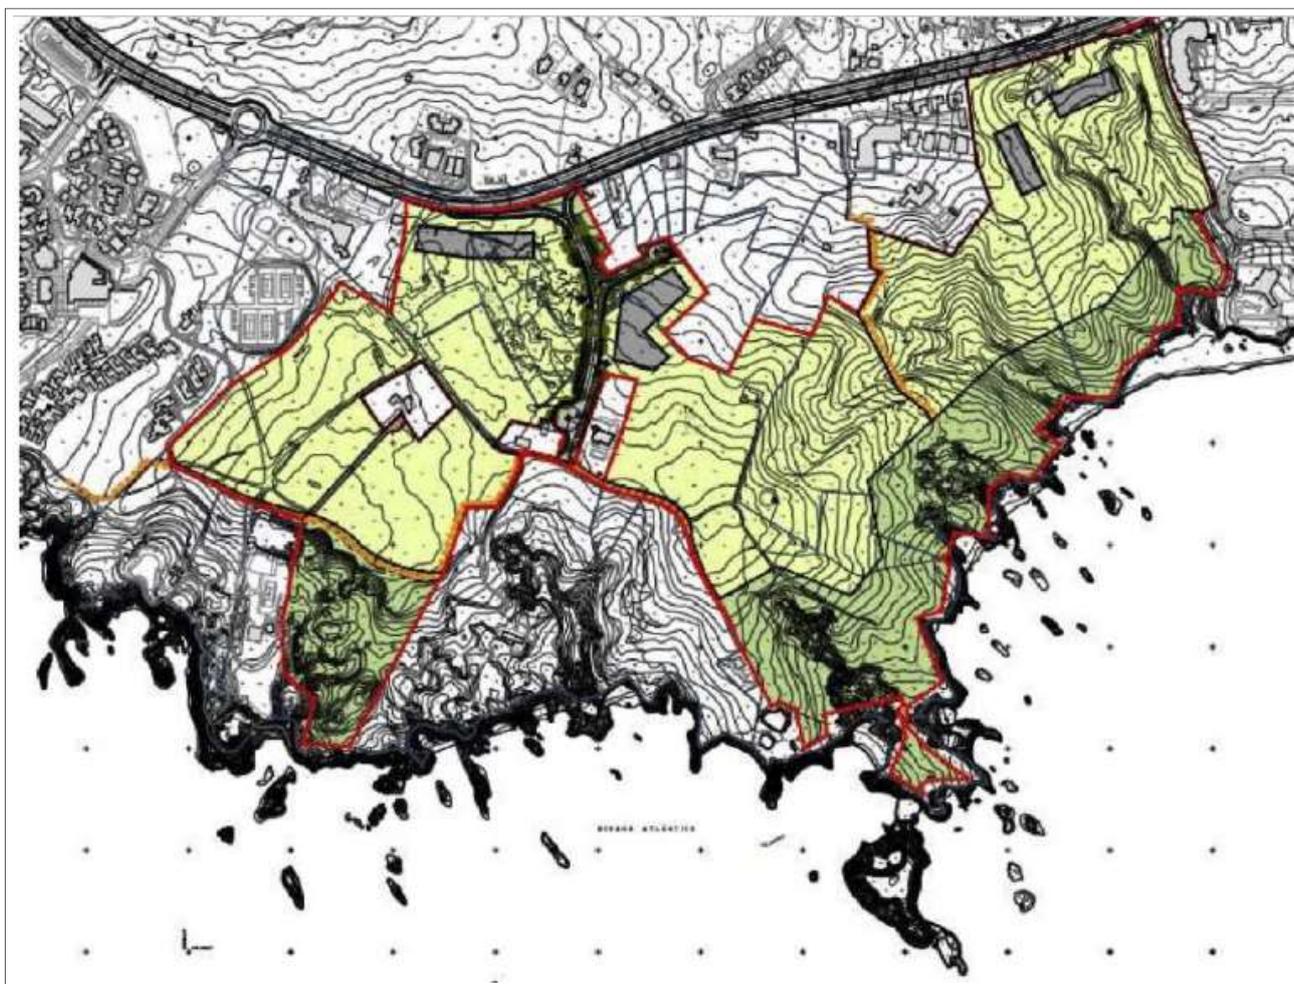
Planta de Síntese com indicação dos polígonos de implantação dos lotes
